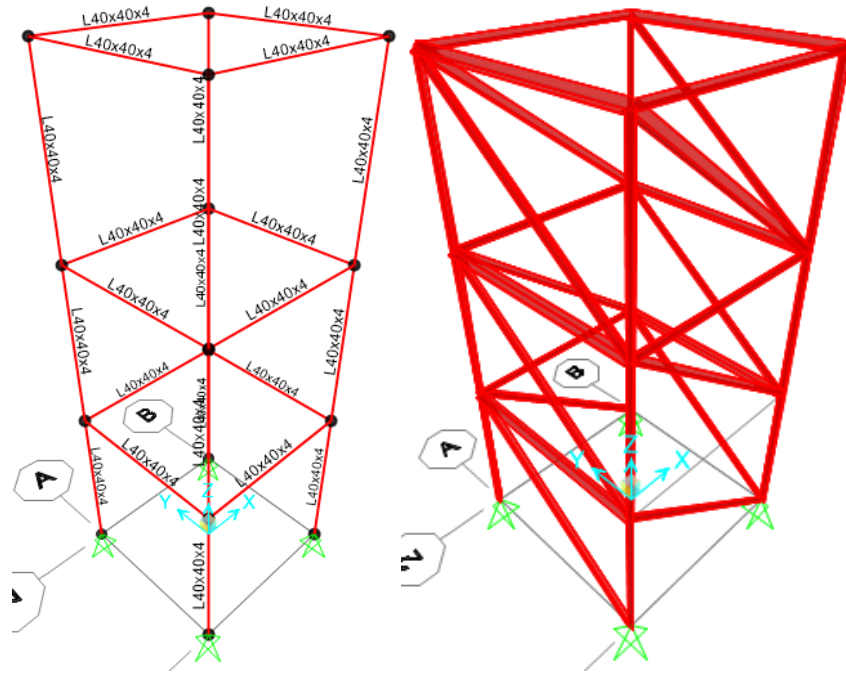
Estructura modular de Acero A36 construida en SAP2000.
